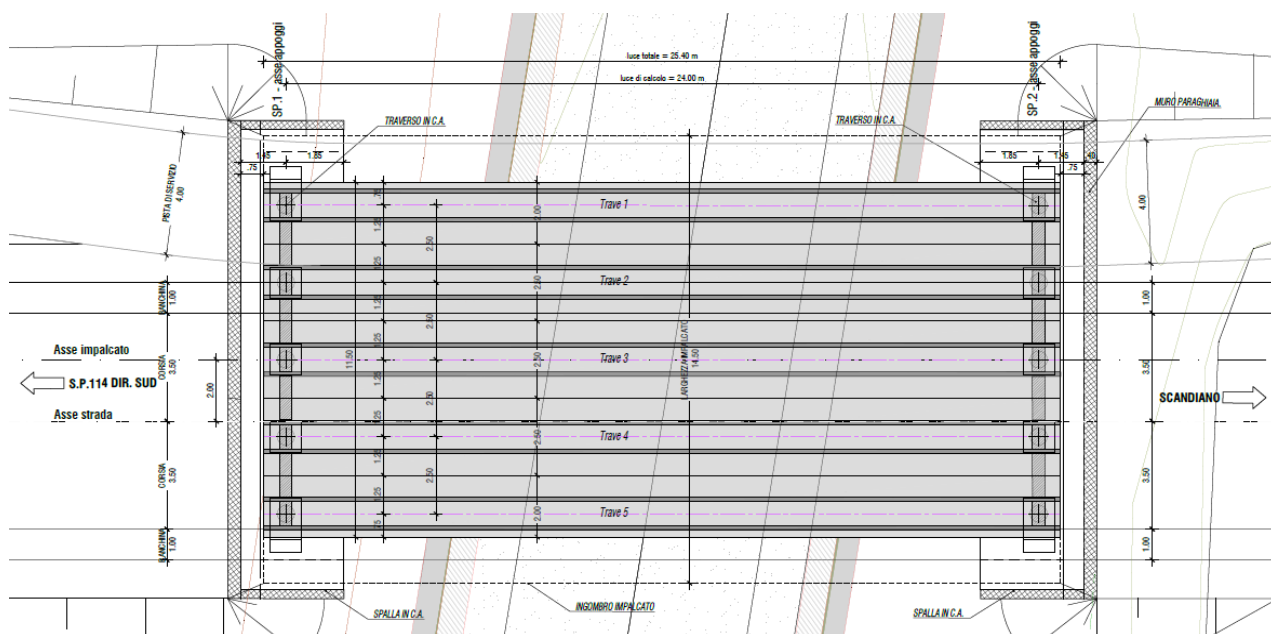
Pianta dell'impalcato (sezione A-A).
